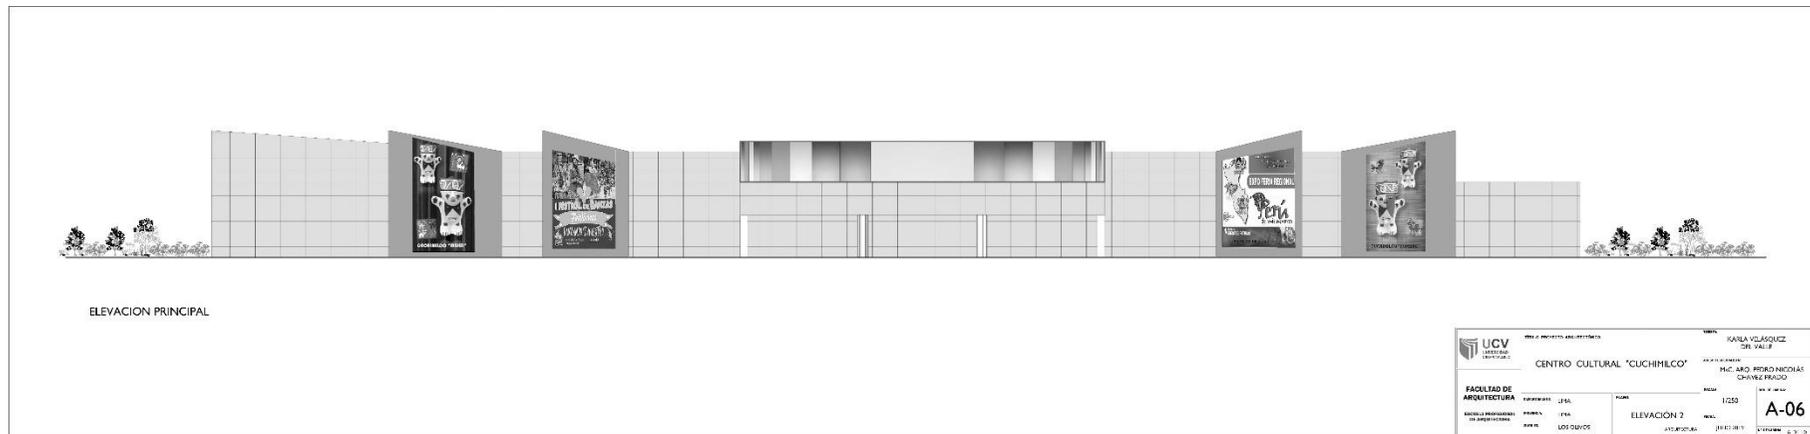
Plano de Arquitectura Elevación Principal. Elaboración propia
